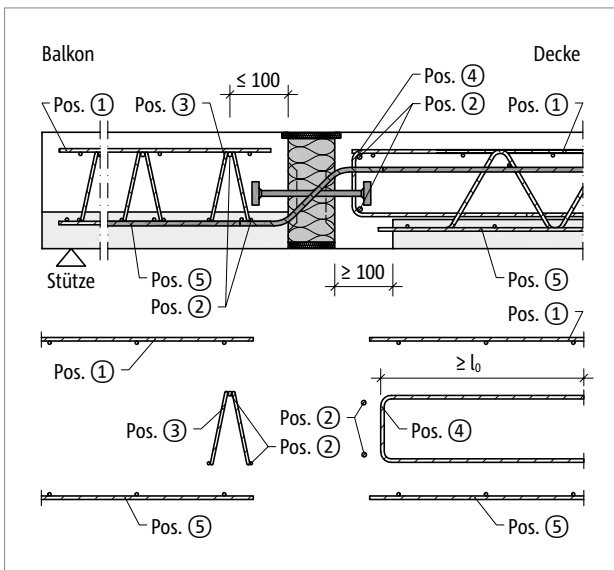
Schöck Isokorb® T Typ QP: Bauseitige Bewehrung mit Gitterträger
